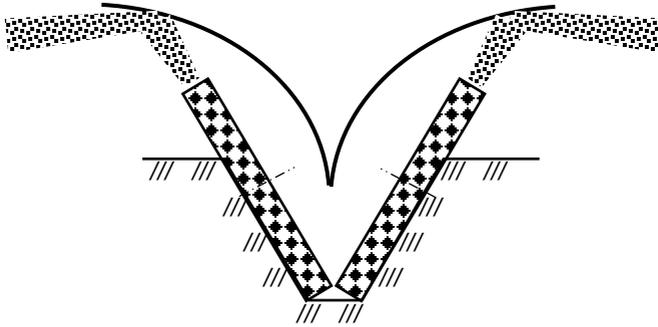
Схема двухфрезерного рабочего органа с отражающими щитами
